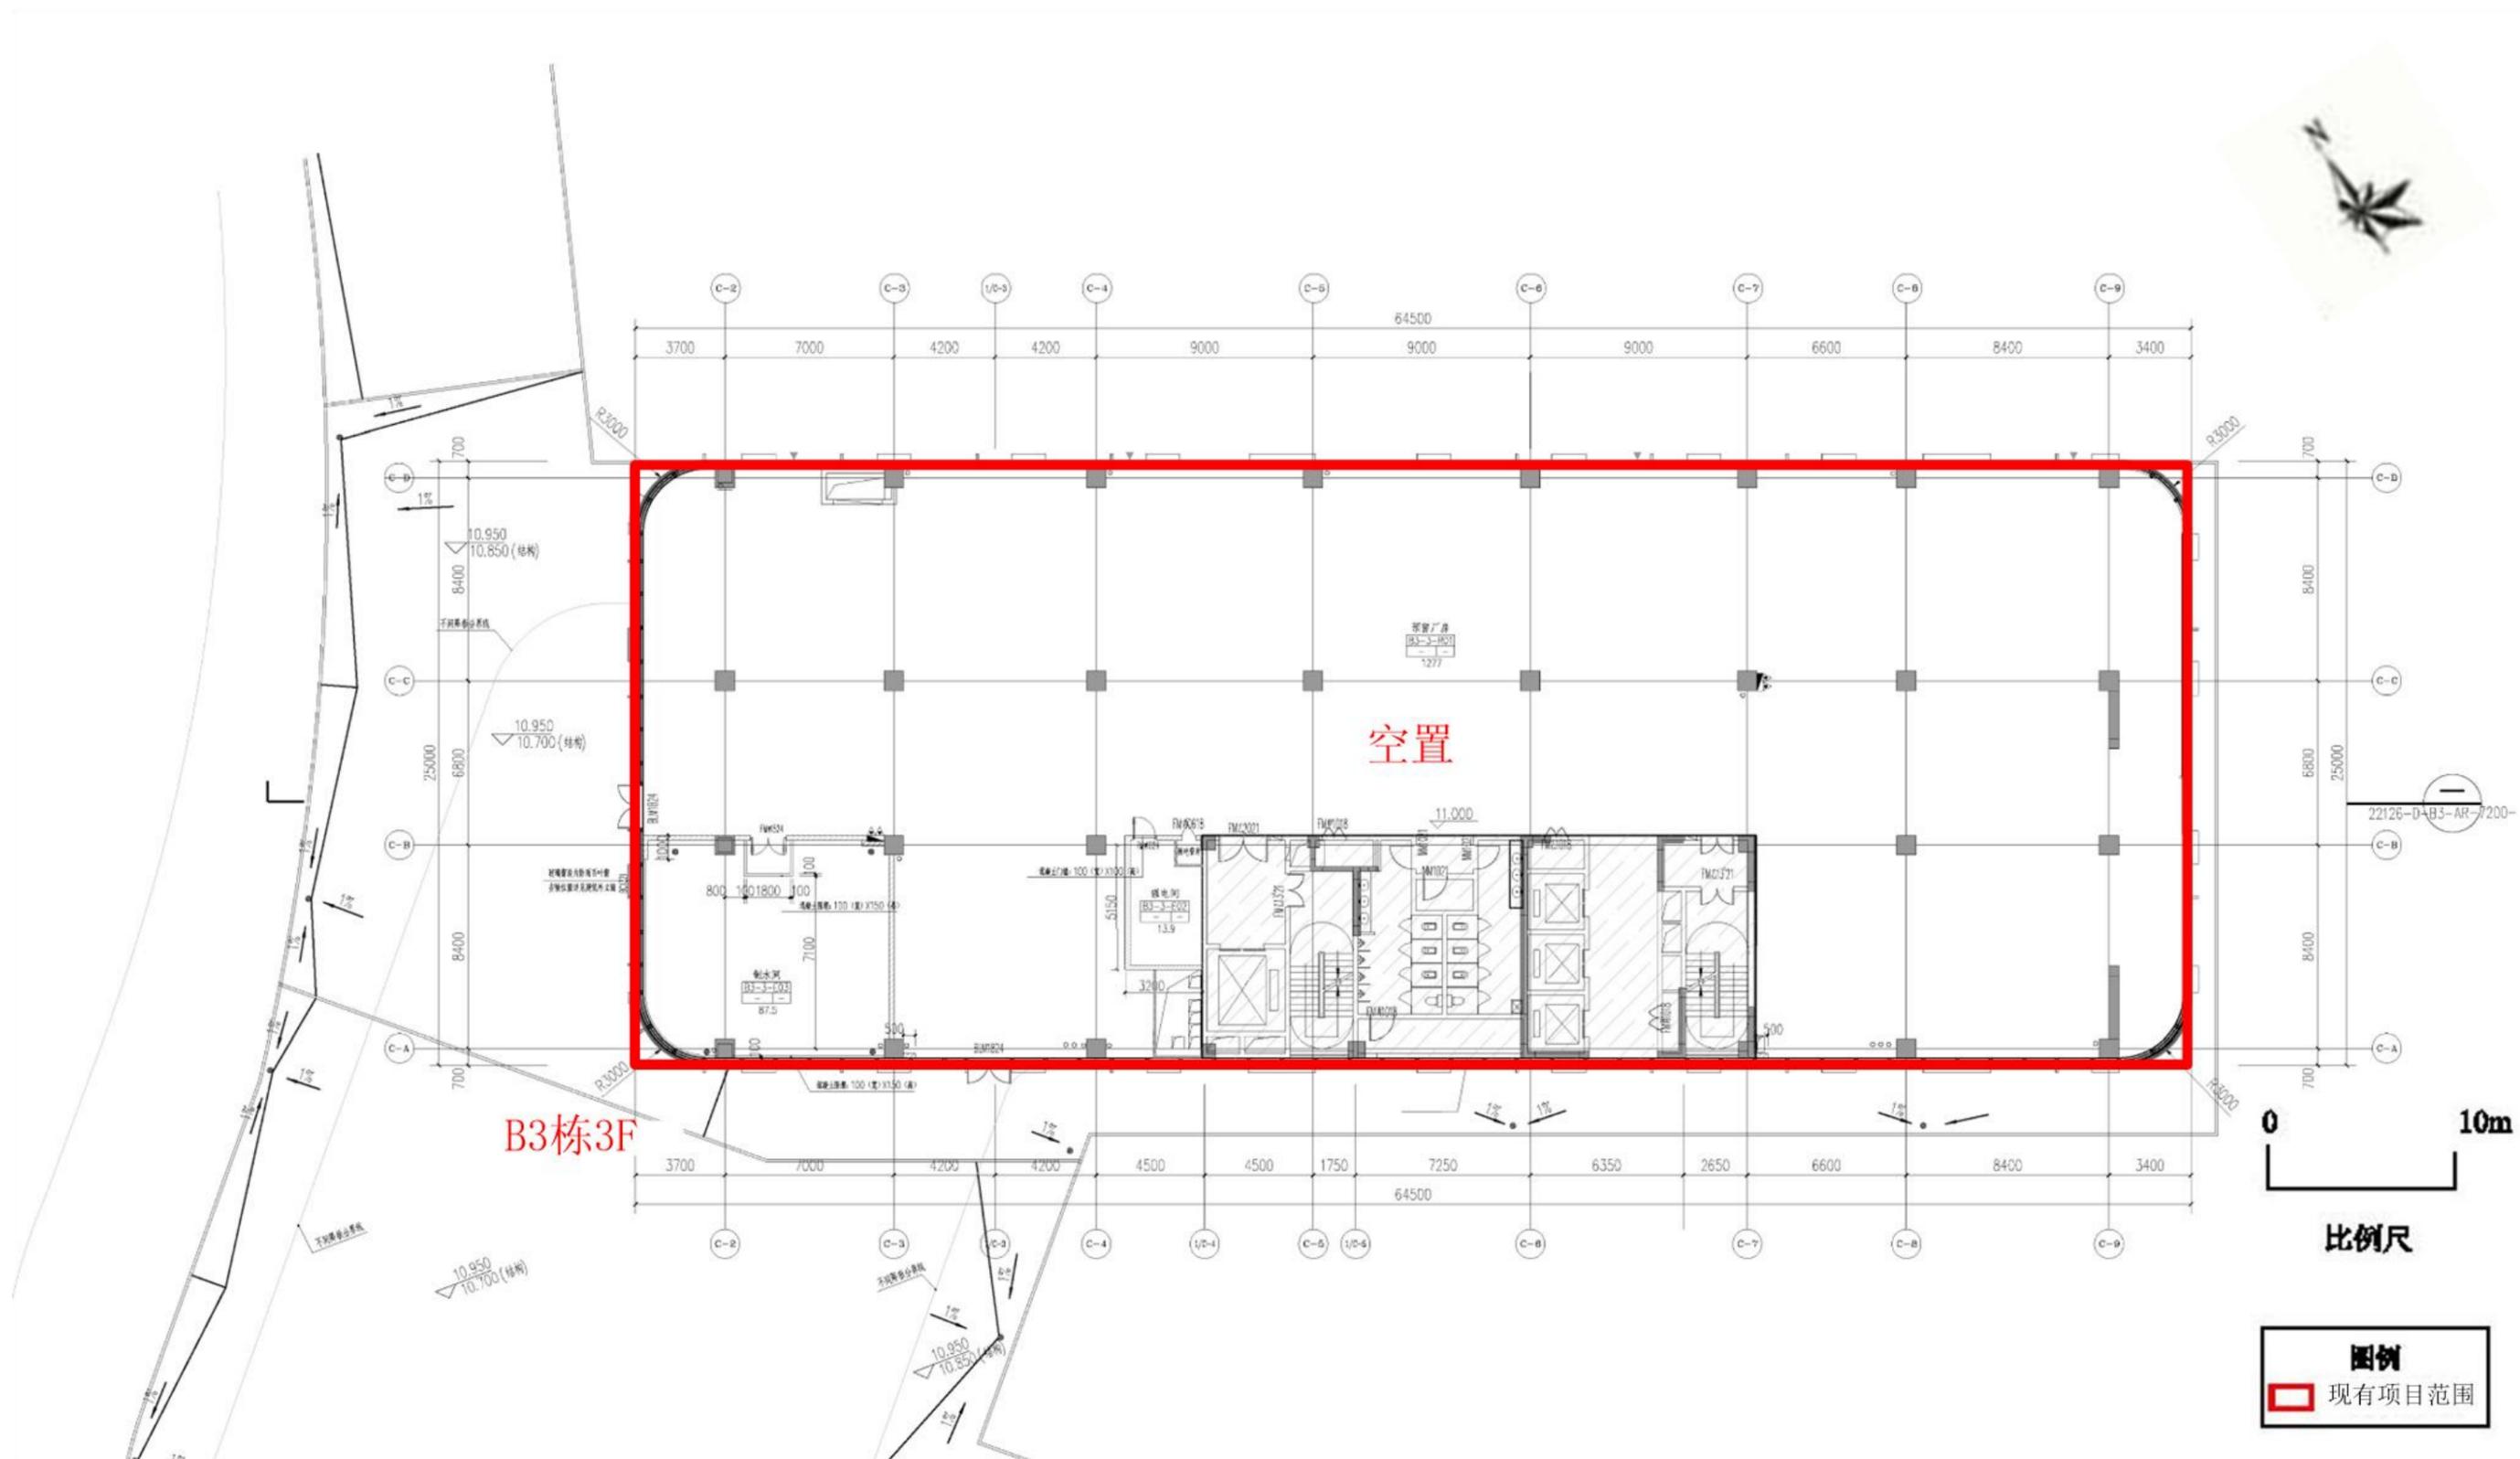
现有项目 B3 栋三层平面布置图 (原规划为液体培养基车间, 尚未建设, 现状空置)
